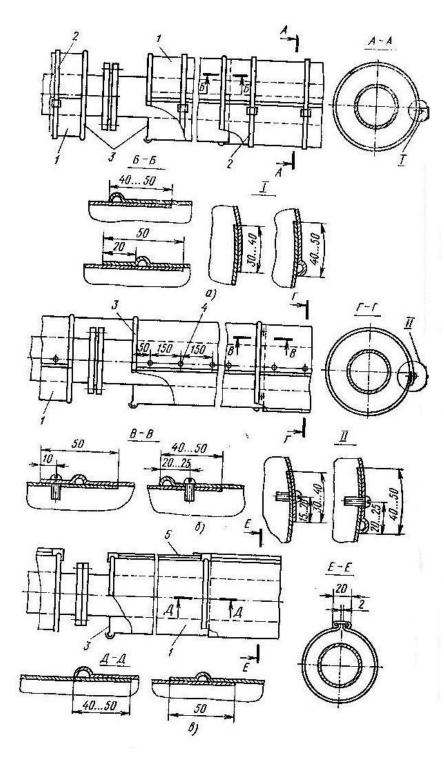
Изоляция оборудования жесткими изделиями на стяжках: — проволочный каркас. 2— теплоизоляционные плиты, 3— бандаж, 4— проволочное кольцо
